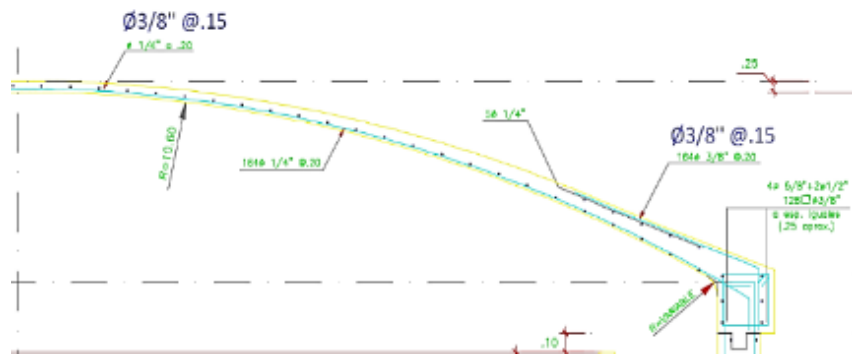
Refuerzo existente en la cúpula y acero calculado.
